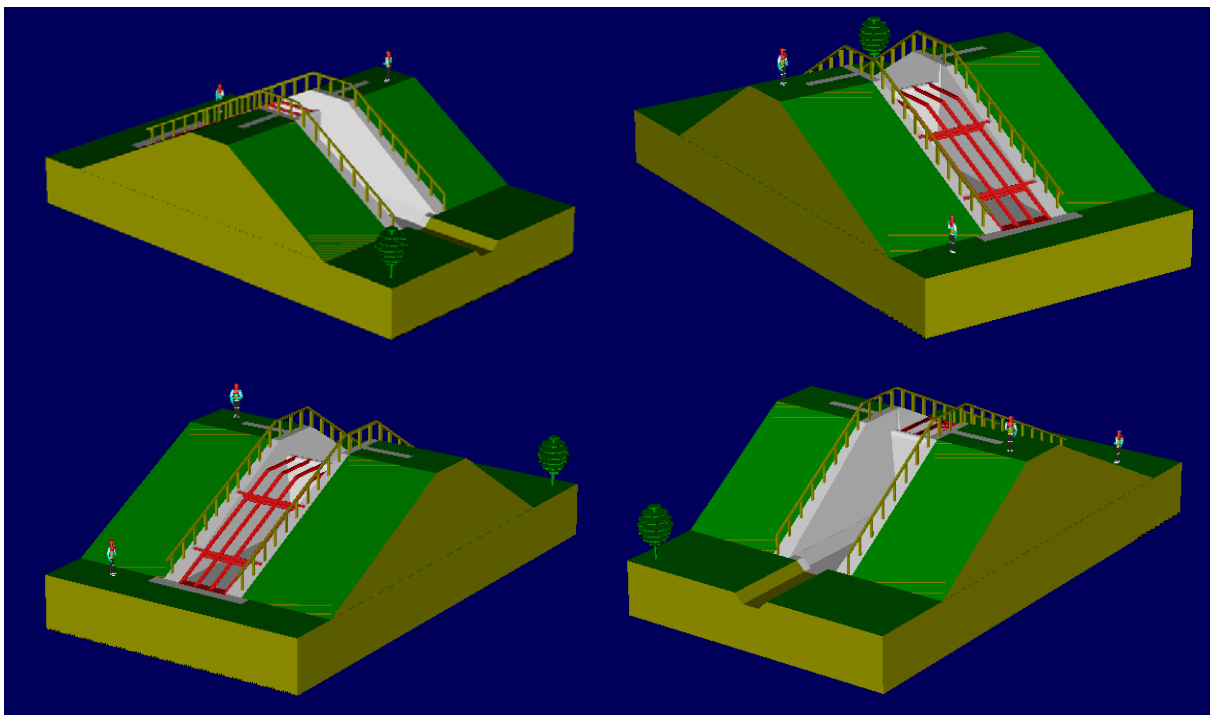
Auslaßbauwerk Rückhaltebecken, Konstruktionsprinzip
